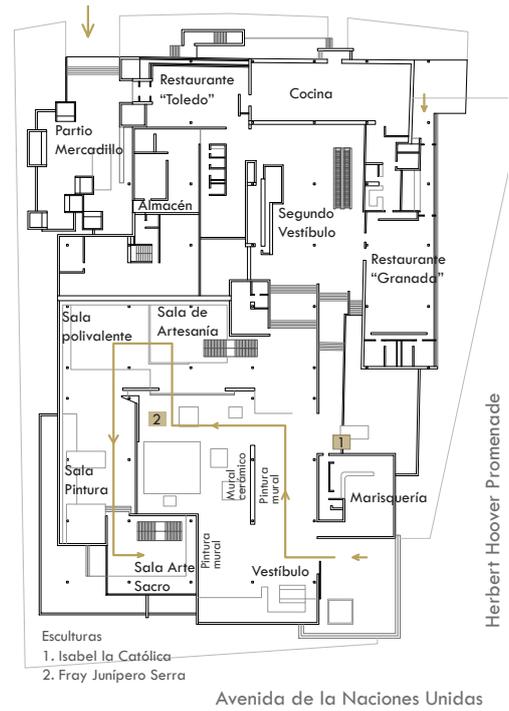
Recorrido exposición planta baja. Elaboración propia.
